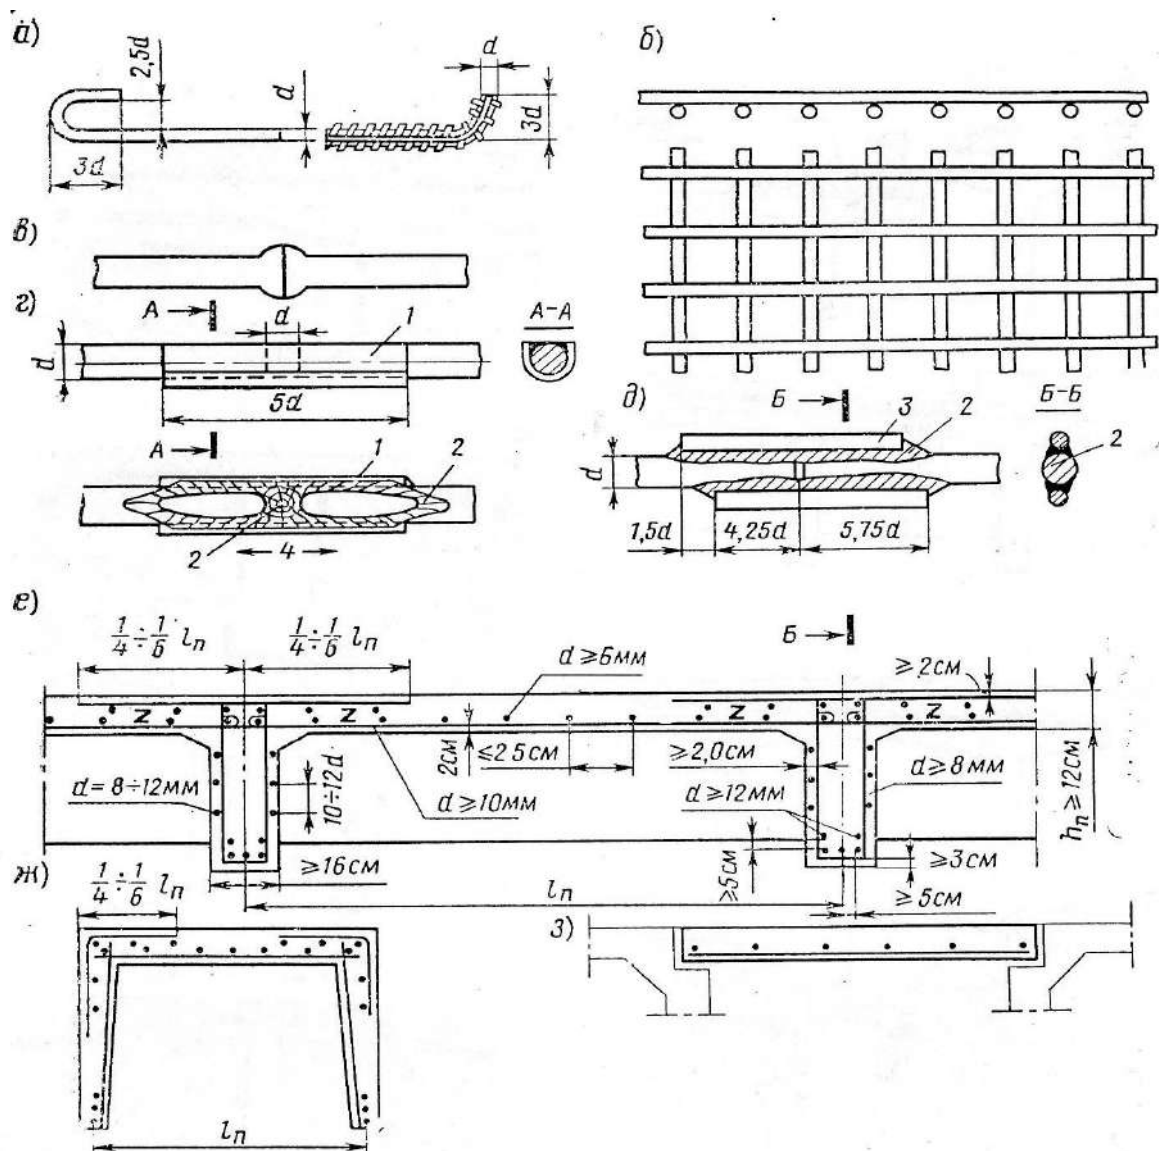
Детали арматуры и армирования плиты проезжей части и главных балок:
